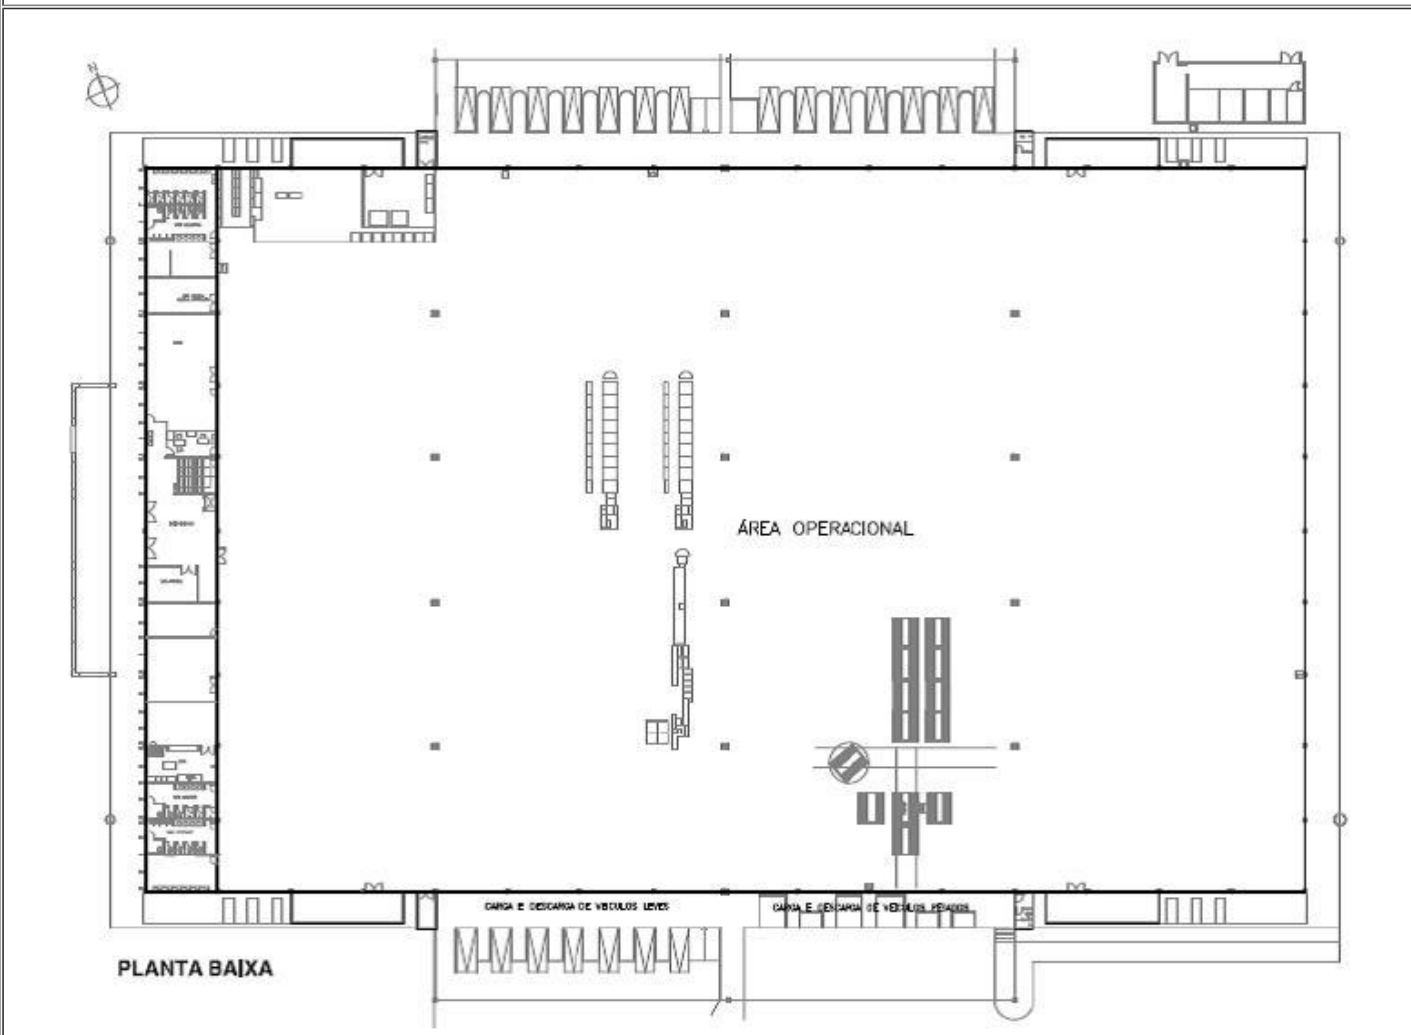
Planta baixa pavimento térreo da situação anterior ao incêndio - Sem escala.
